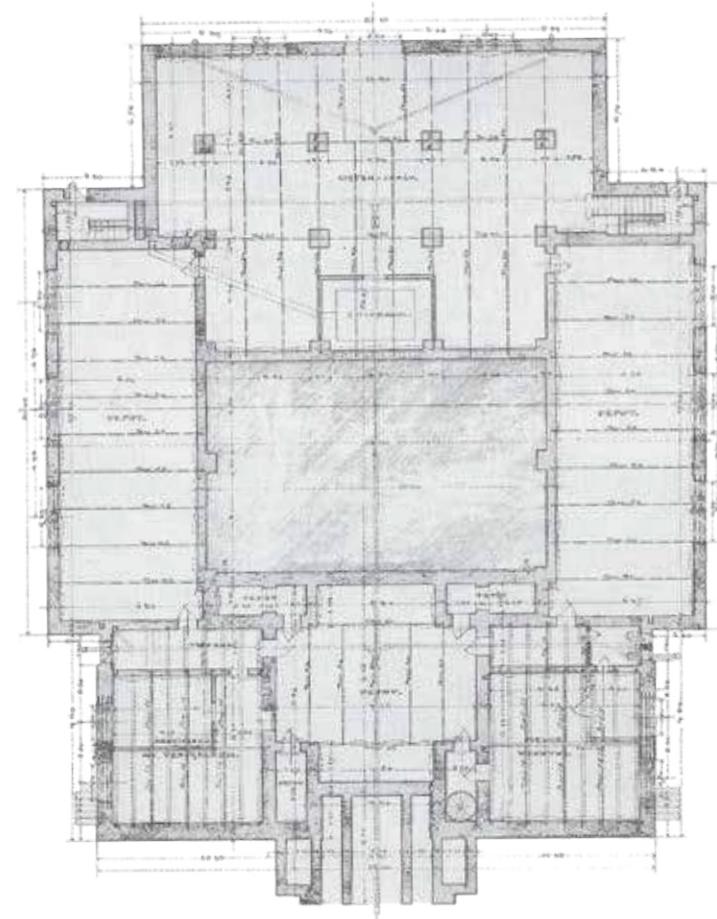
Grundriss Untergeschoss (Souterrain) Maßstab ca. 1:350
